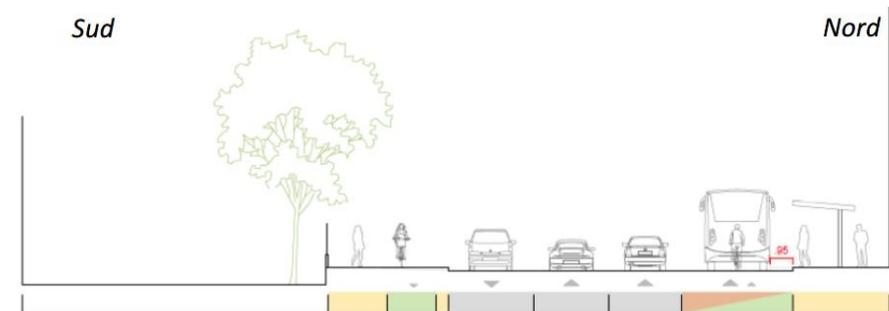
Coupe 1D-2 projet alternatif - station Carnot
